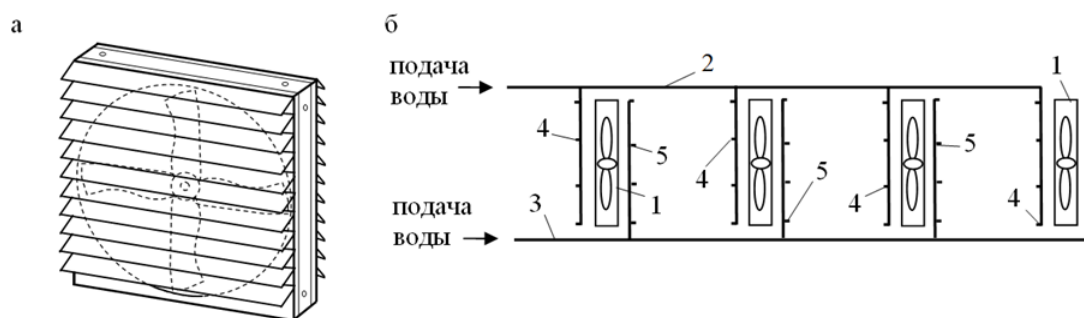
Схема устройства побуждения воздухообмена и кондиционирования для животноводческих ферм: а) общий вид вентилятора с направляющими жалюзи; б) схема взаимного расположения вентиляторов и распыляющих форсунок (вид сверху); 1 – осевые вентиляторы; 2, 3 – ветки водопровода высокого давления; 4, 5 – группы распылительных форсунок веток водопровода 2 и 3 соответственно
